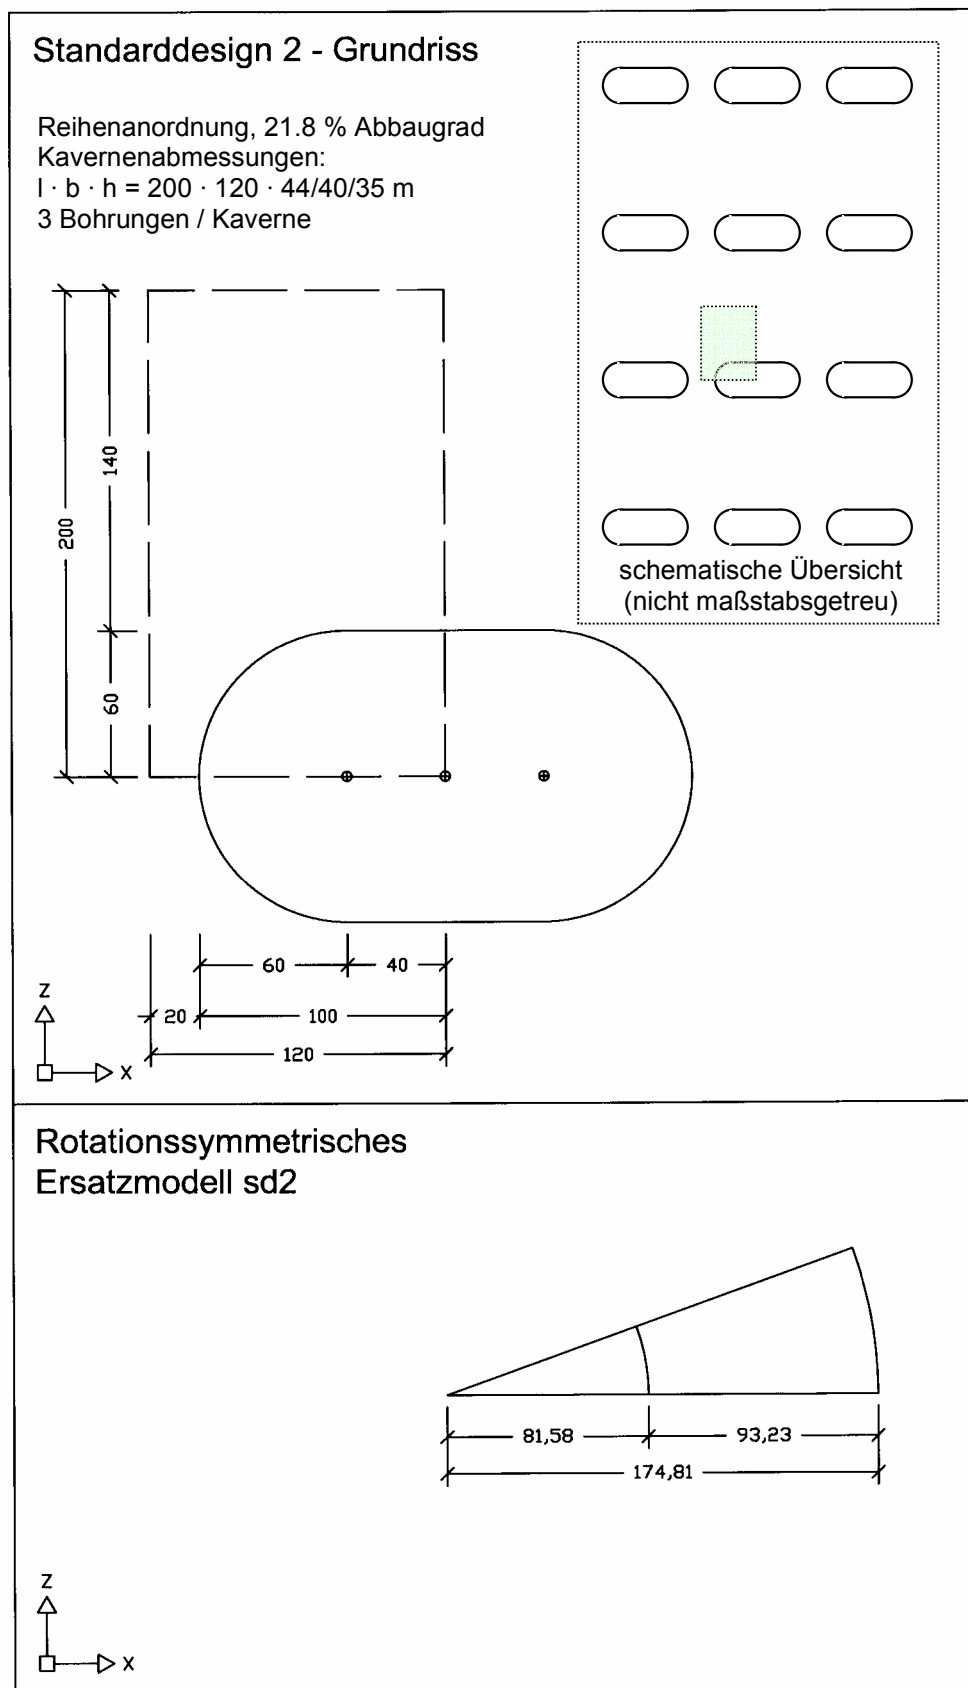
Standarddesign 2 – Grundriss und rotationssymmetrisches Ersatzmodell
